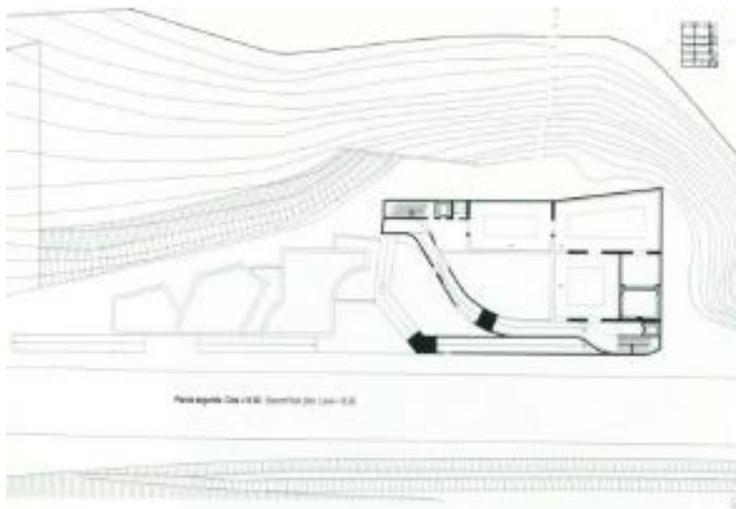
Planta baixa - segundo pavimento – cota +16.90
